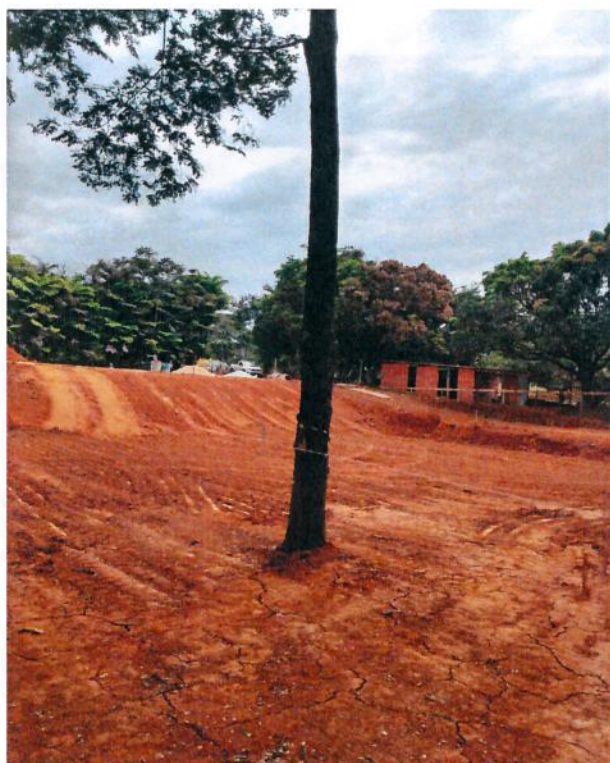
Óleo copaíba situado na área de Construção, e mangueiras na lateral esquerda que serão preservadas.
